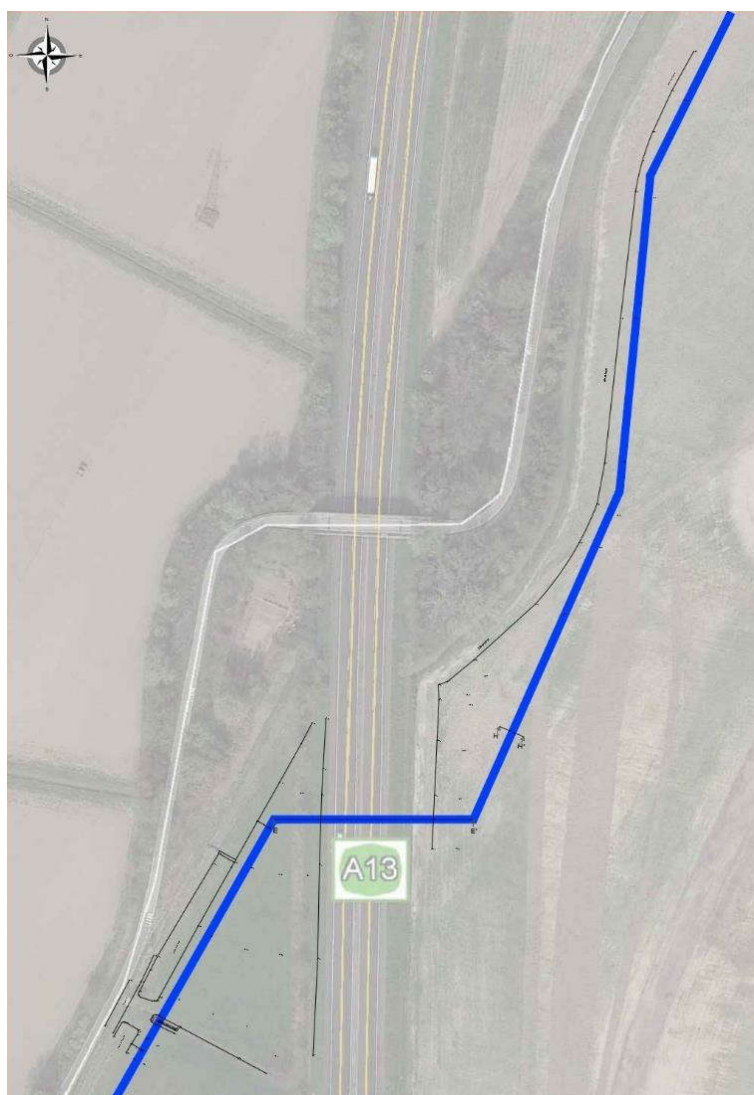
Tratto E-E' - Rilievo planoaltimetrico post-intervento
